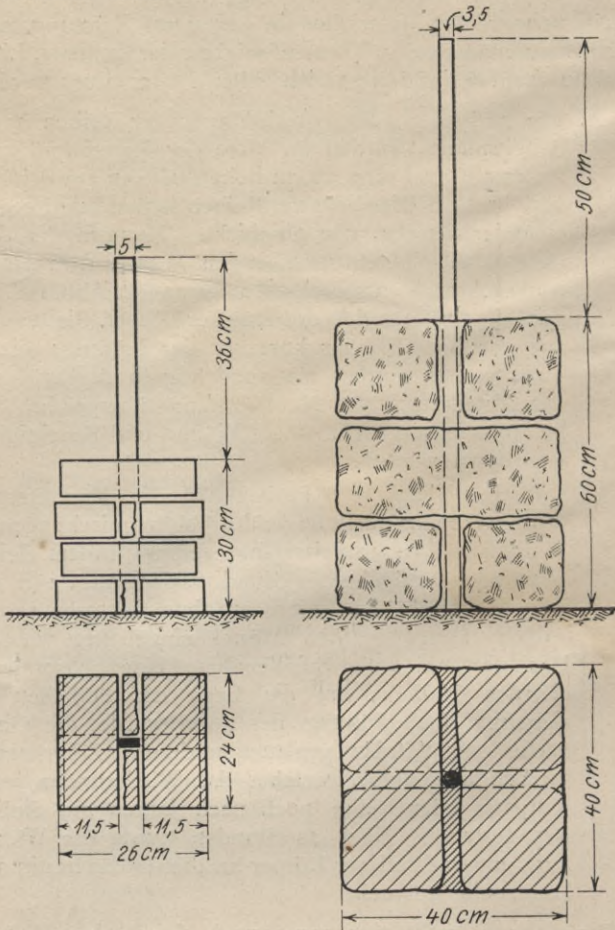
Ziegel- und Bruchsteinkörper mit Flacheisen und Rundeisen.
